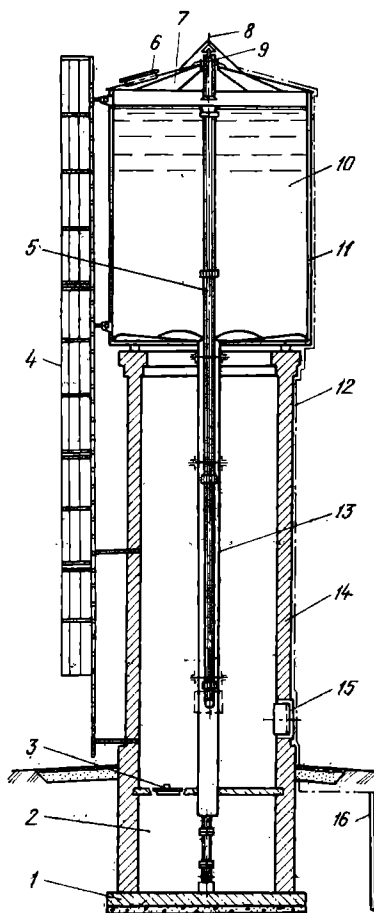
Железобетонная бесшатровая водонапорная башня:
